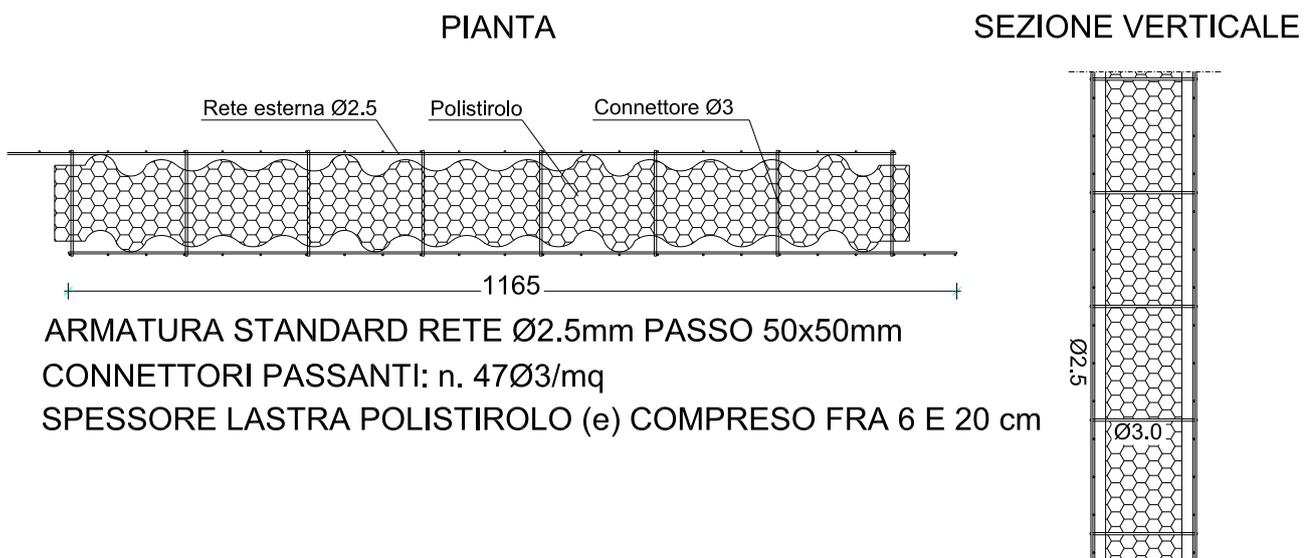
Pianta e sezione verticale del pannello singolo di tamponamento, NITRA.
